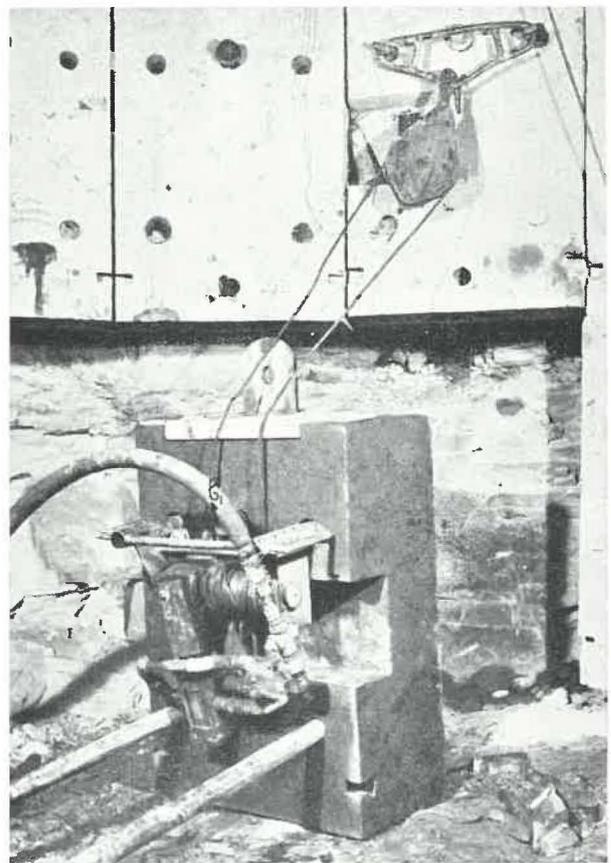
Treuil Hausherr pour la mise en place des claveaux.
